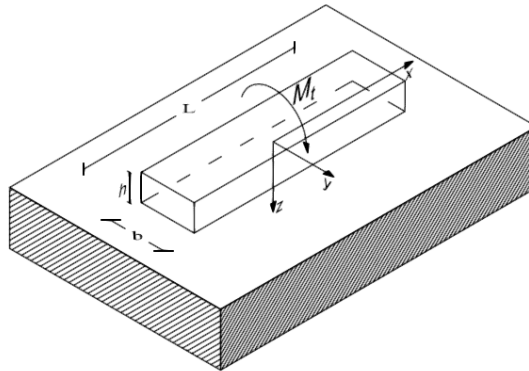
Trave di fondazione soggetta a coppia torcente in mezzeria.
